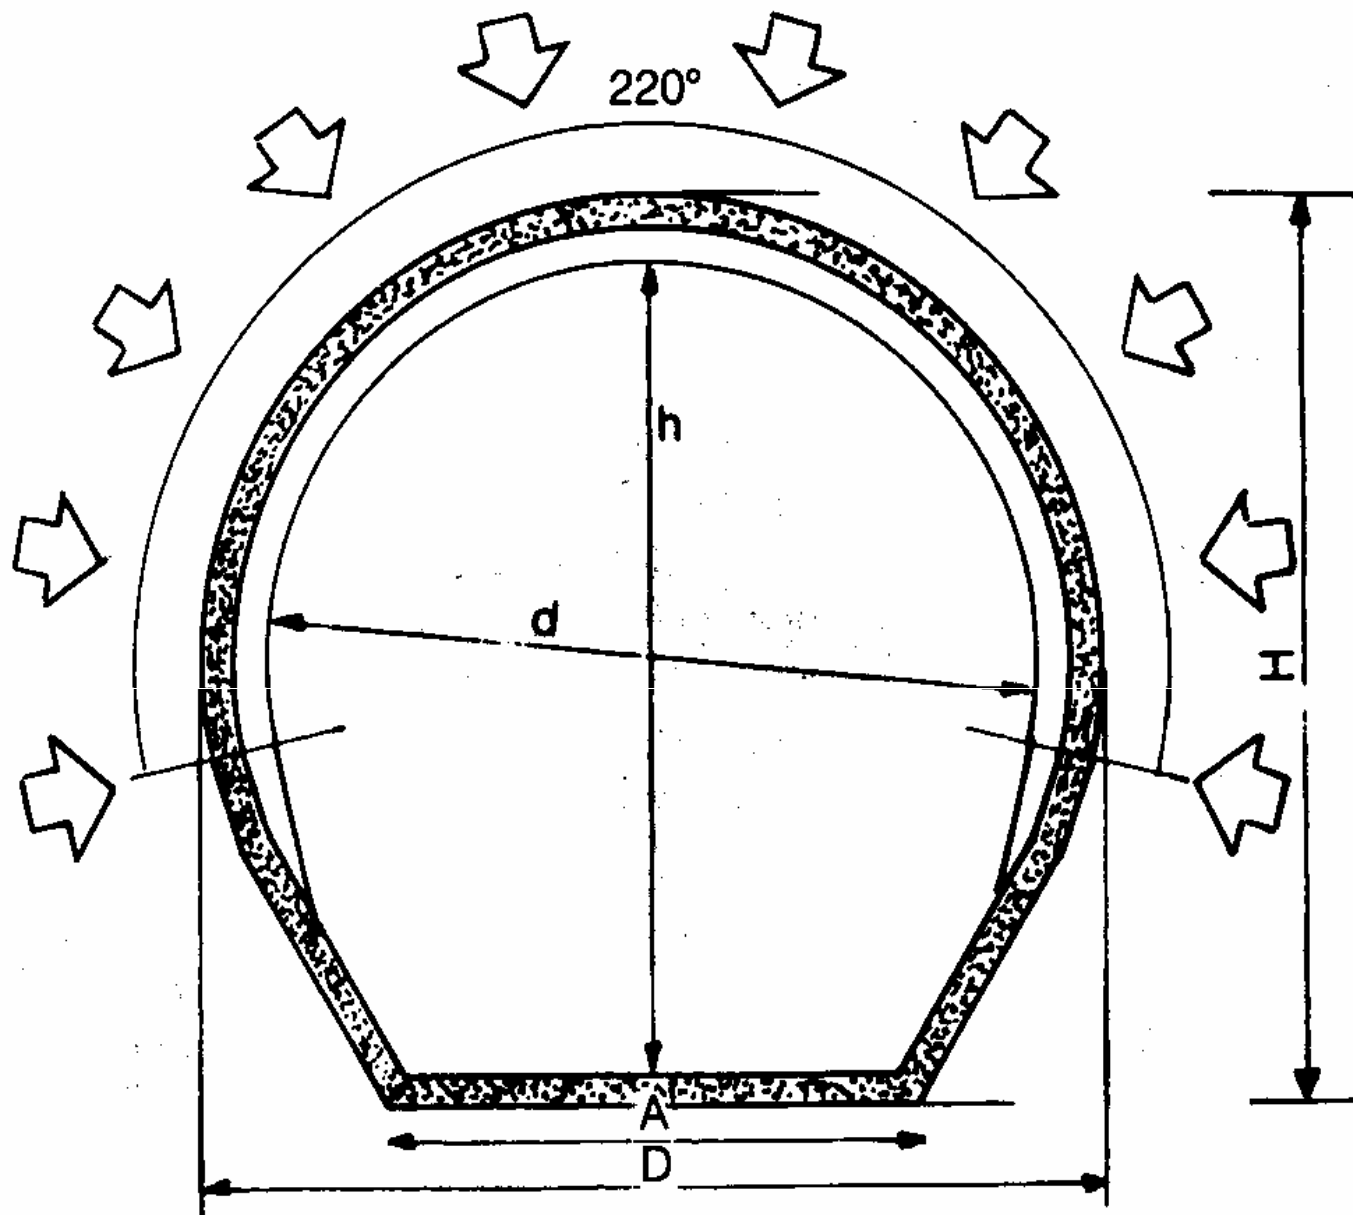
Tubo para drenaje de PVC, ondulado y sección abovedada, tip Glassi-Dren
